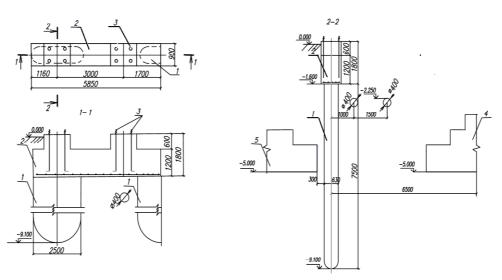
Фундамент из спаренных бареттов: 1 – баретта; 2 – ростверк; 3 – болт анкерный; 4 – фундамент существующего цеха; 5 – фундамент газоотсасывающей станции; 6 – существующие трубопроводы
